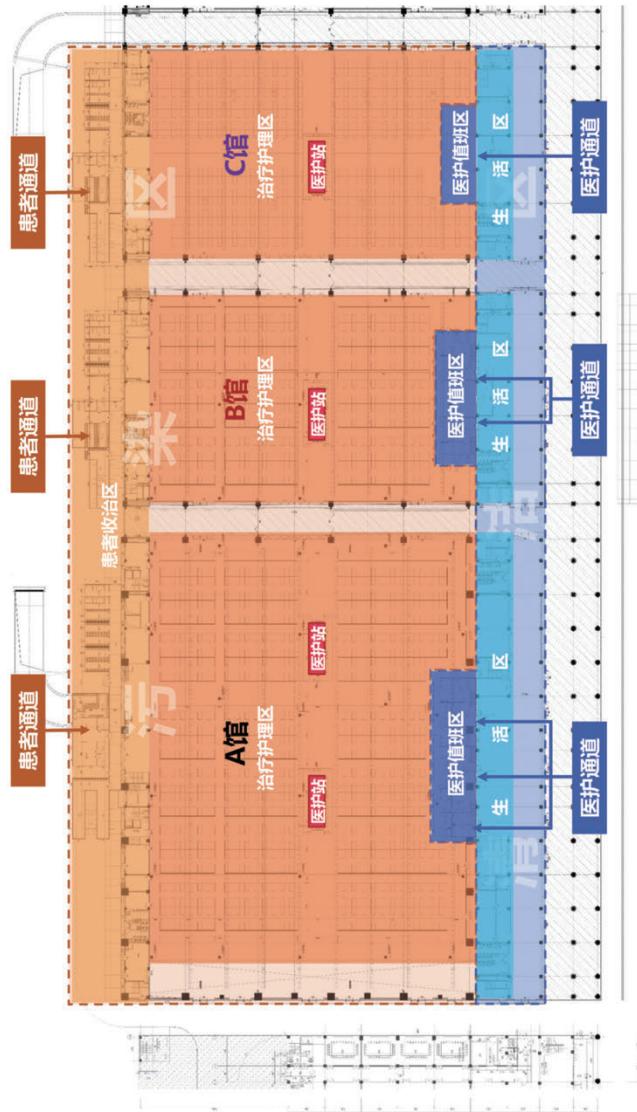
卓尔(武汉客厅)方舱医院平面布置图
